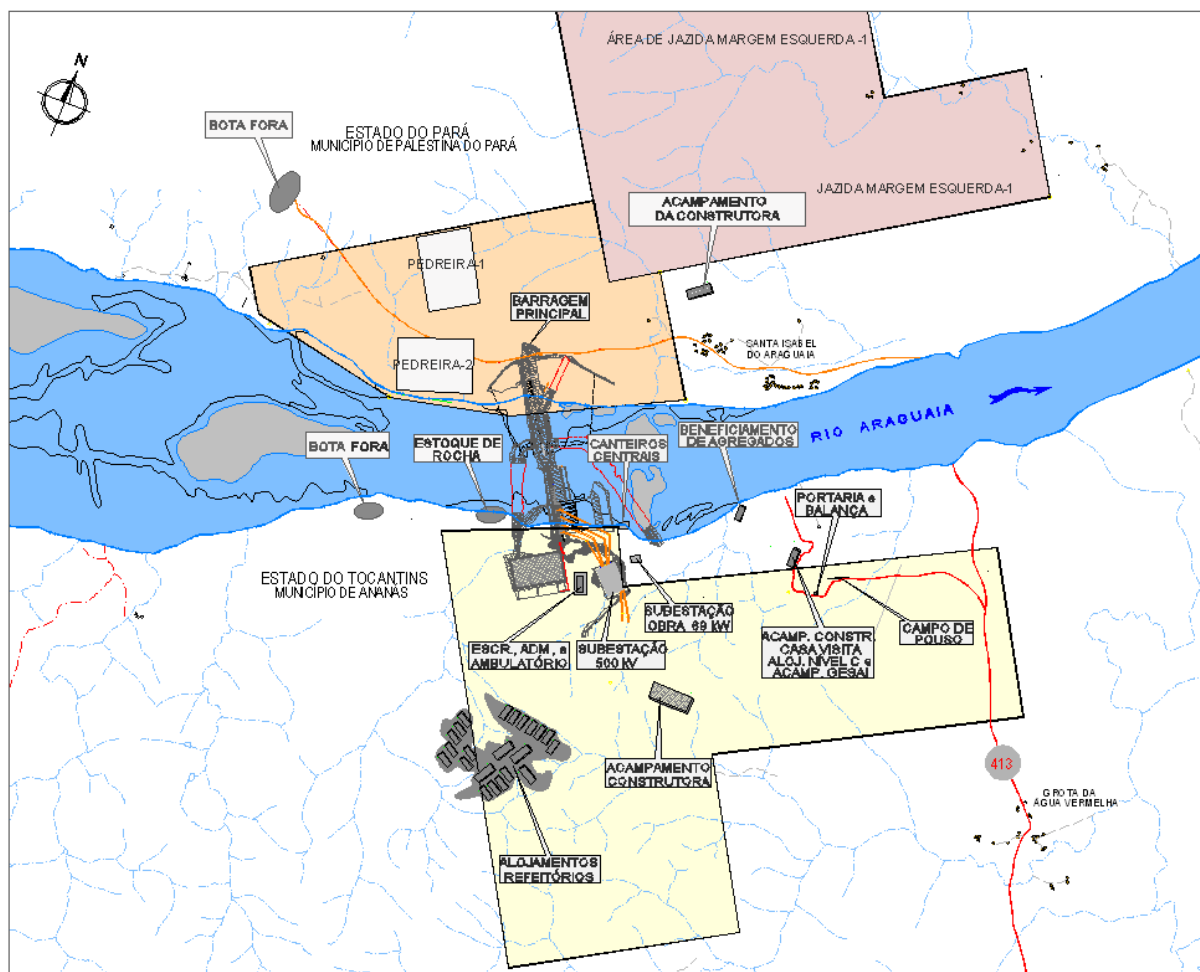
Planta de localização das áreas de empréstimo, jazidas e pedreiras.
